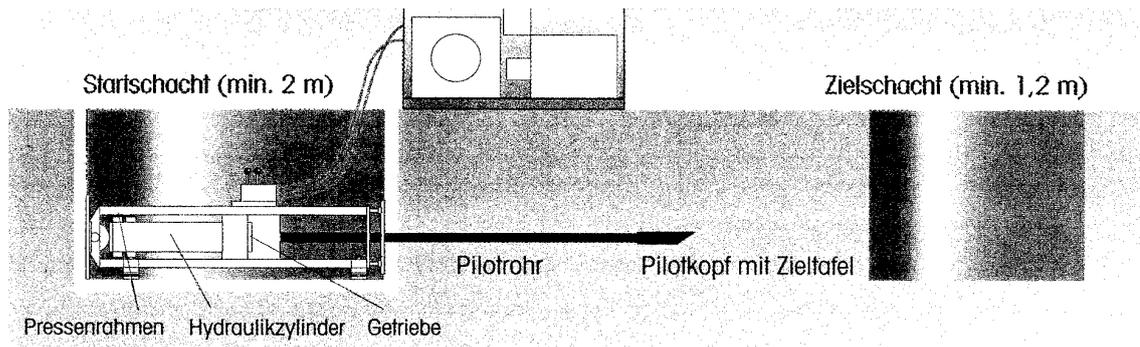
Vorpressen des Pilotrohres (gesteuert) [1]
